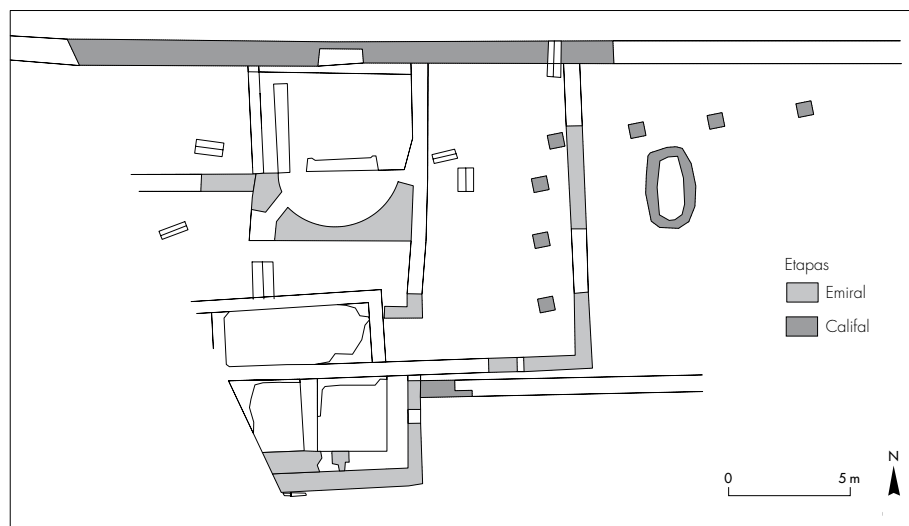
Planimetría del edificio de baños. Restitución por fases.
